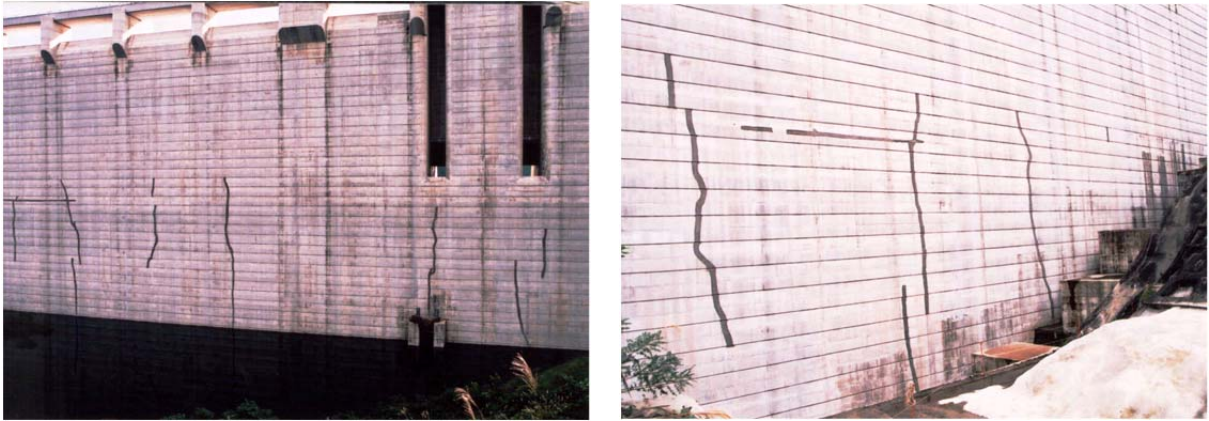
RCD 工法による重式コンクリートダムに発生した鉛直ひび割れの例（ひび割れ補修後）
